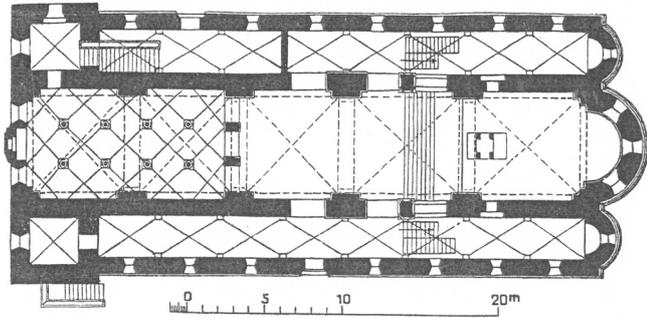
Germerode, Klosterkirche, Grundrissrekonstruktion nach Thümmler, aus: Thümmler, *Stiftskirche*, 65.
